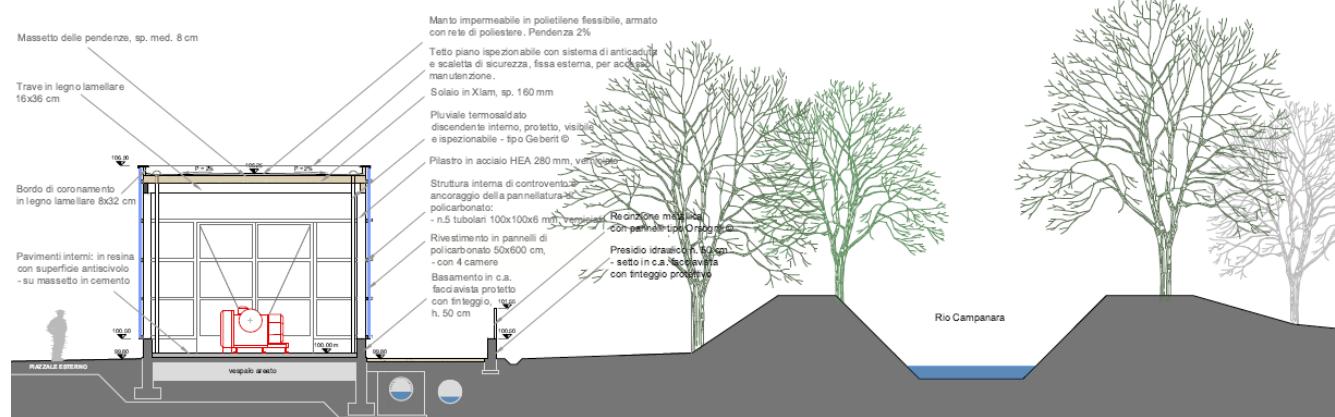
PROSPETTO NORD E SEZIONE TRASVERSALE DELLA CENTRALINA IDROELETTRICA
